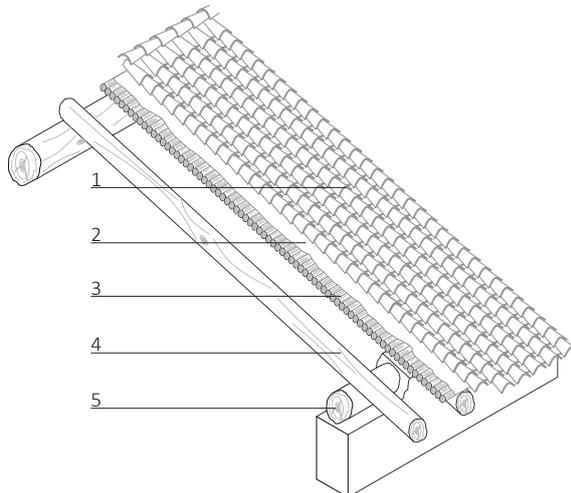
Detalle cubierta correas y cañizo Fuente: propia
